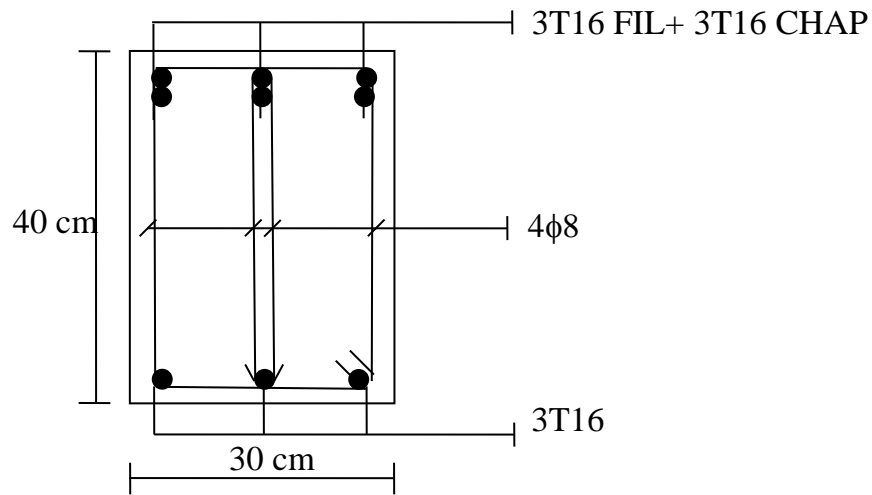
Schéma de ferrailage de la poutre principale (en appui)
